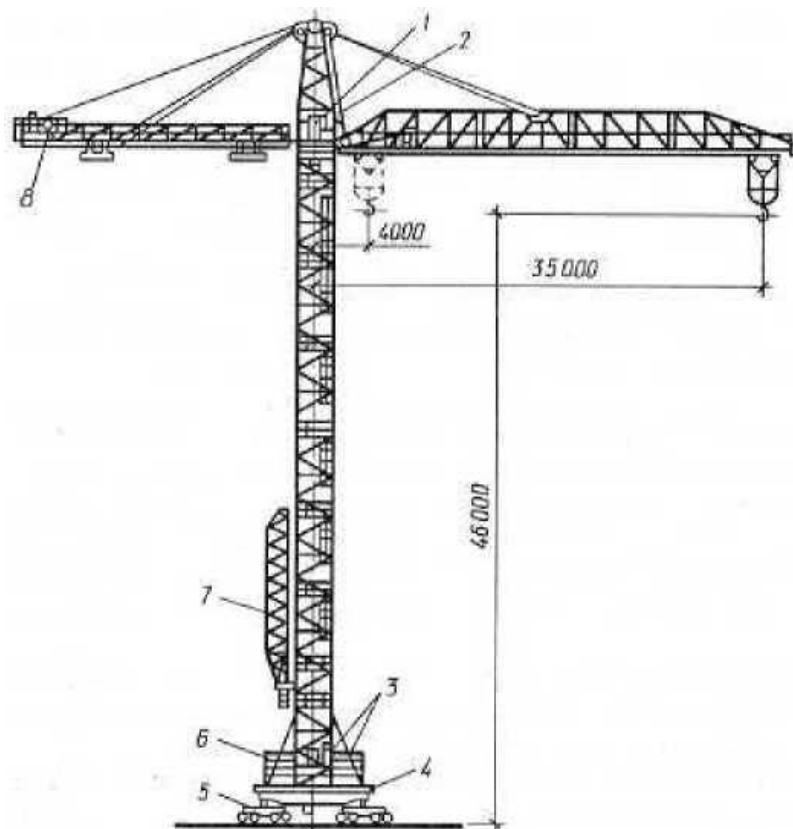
Башенный кран КБ-100 с поворотной башней
